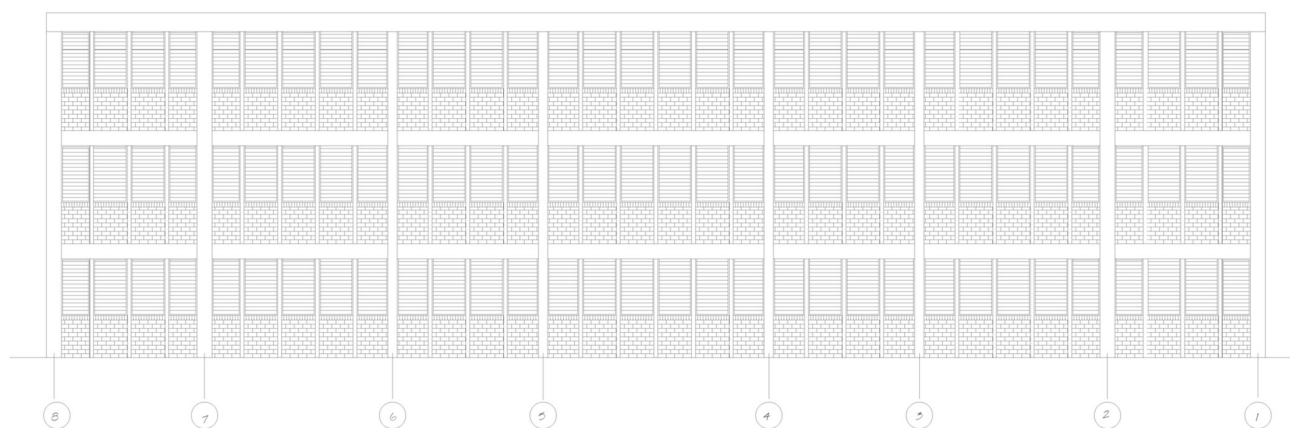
Planos Arquitectónicos – Fachada posterior.
